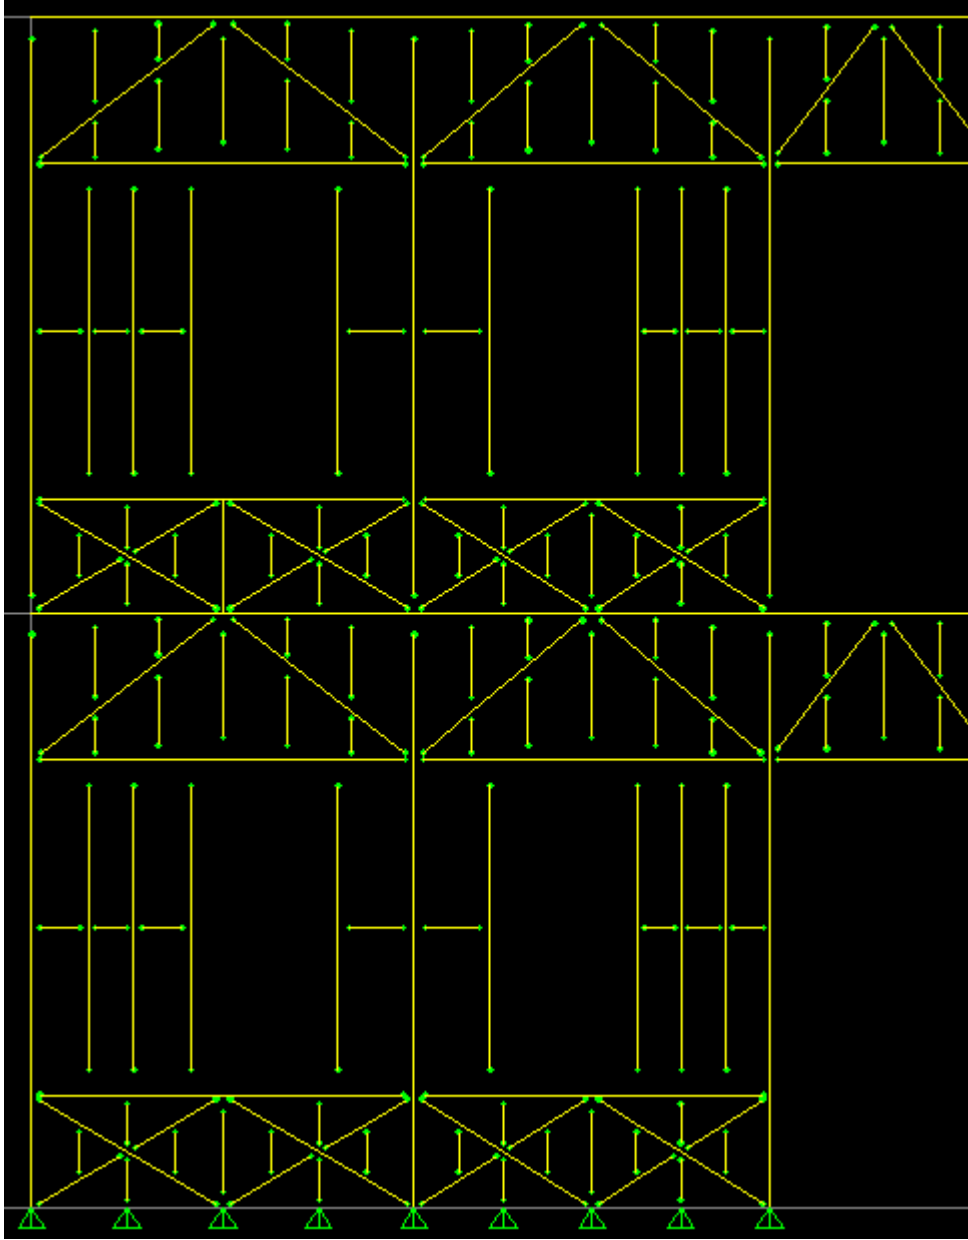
Kat planında üst makas, üst başlıkların bağlantısına ait model görünümü.
